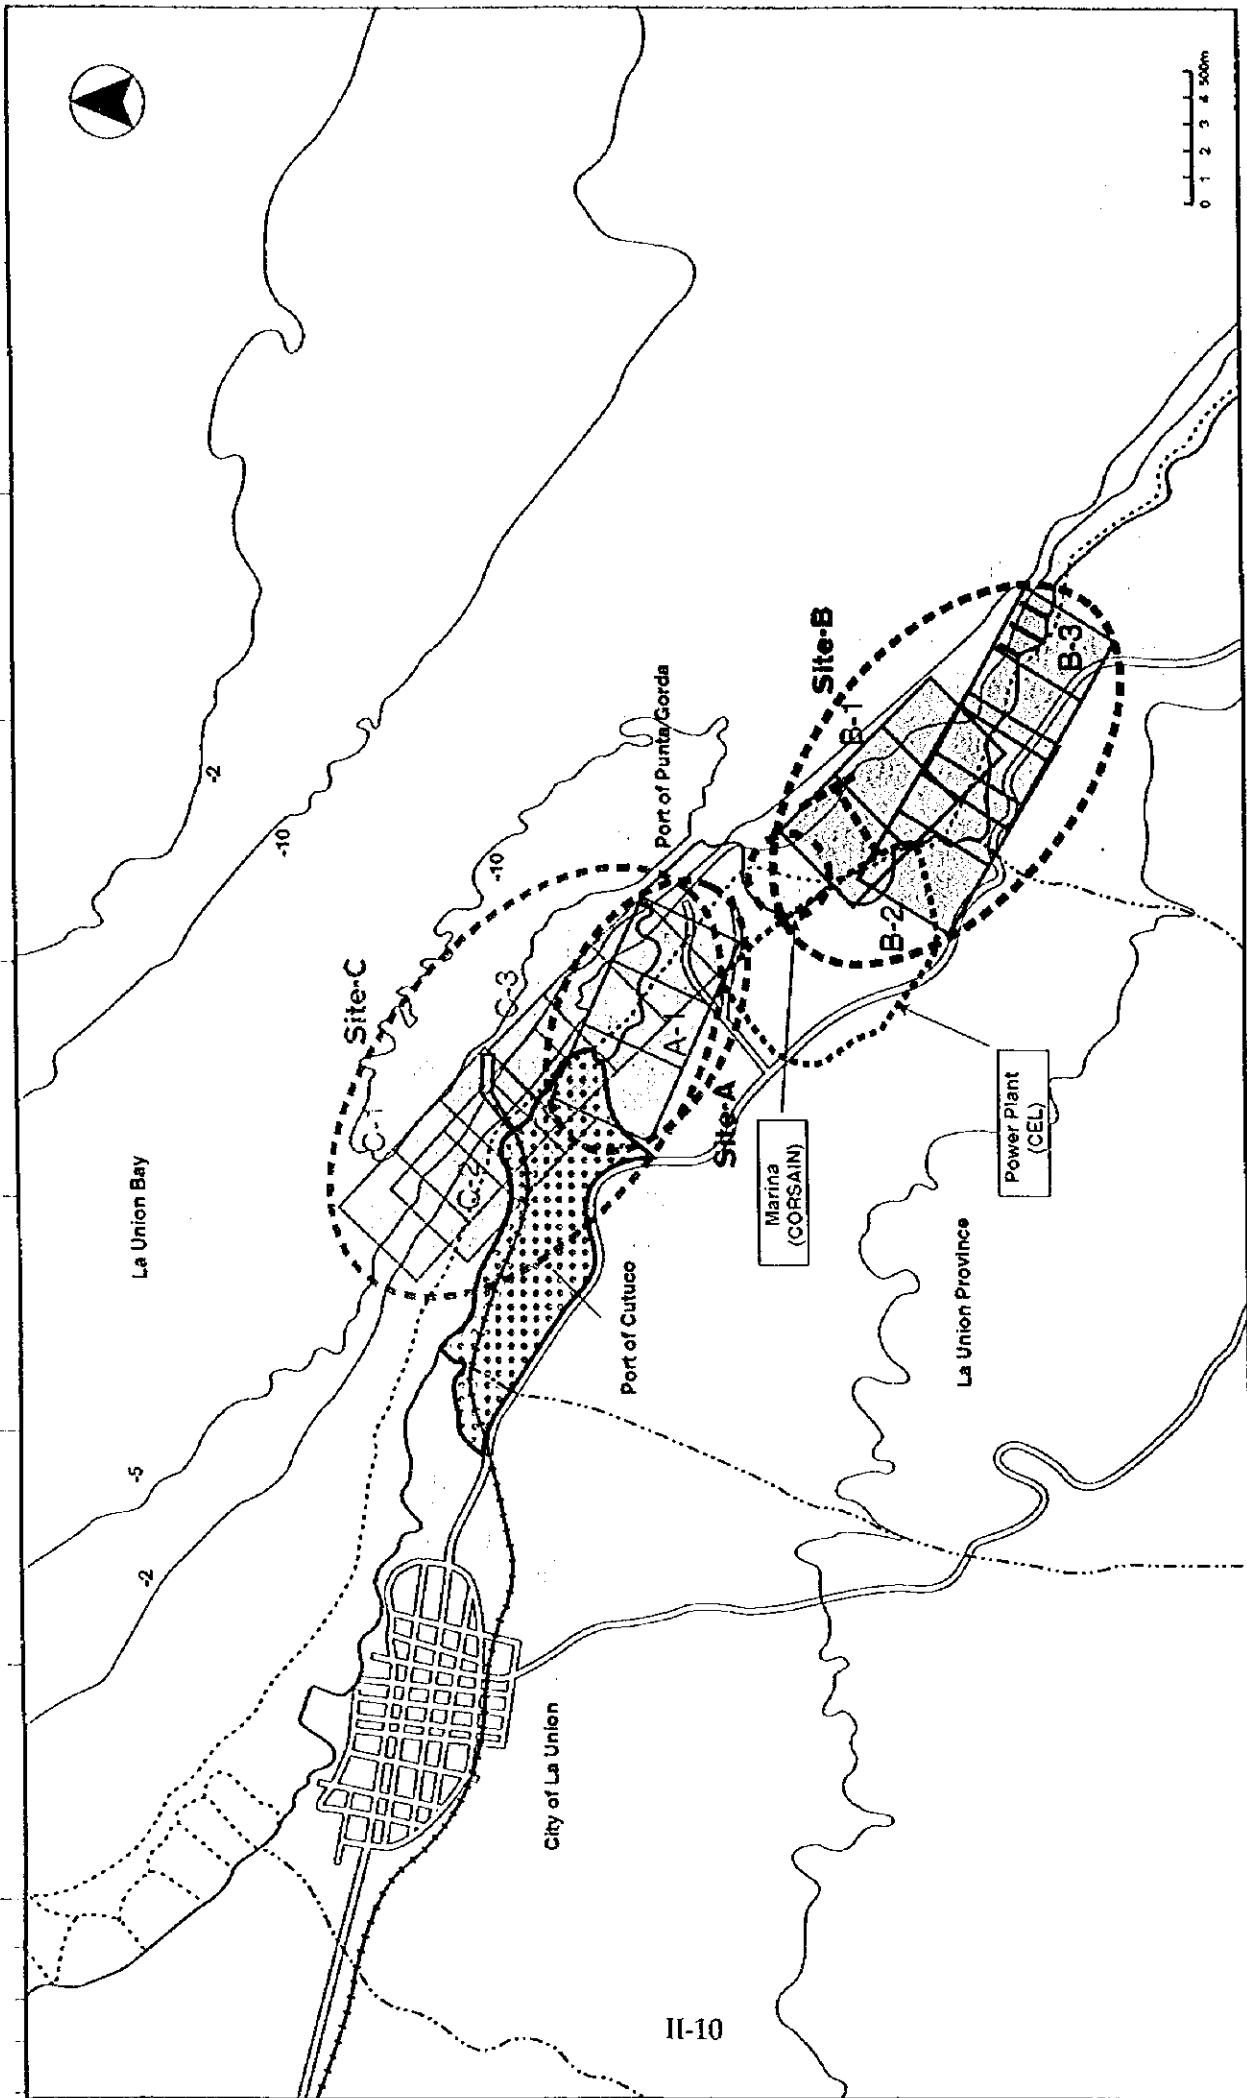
Planes Alternativos de Disposición (Sitios A, B y C)
